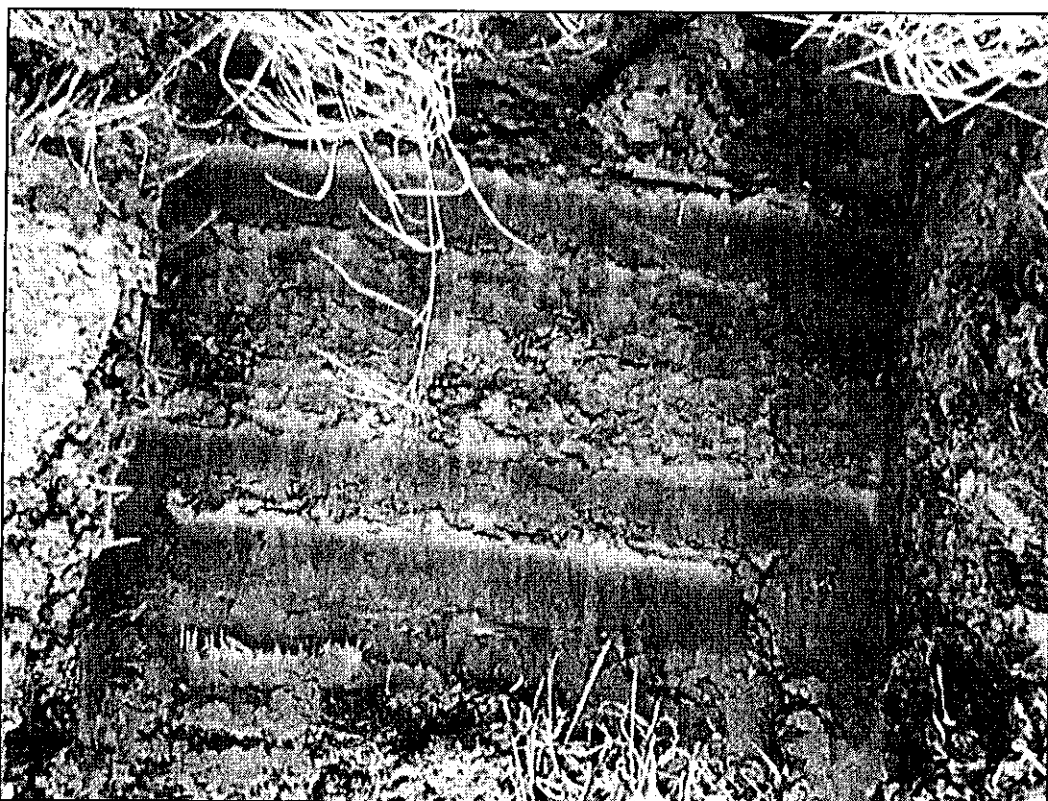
Pozzetto n° 21. Profondità -1,3 m dal p.c.
